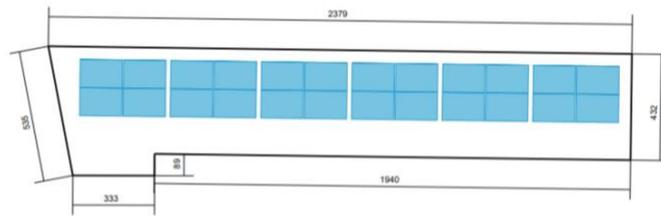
Kirchstrasse 6, Belegungsplan, Dachfläche 1
